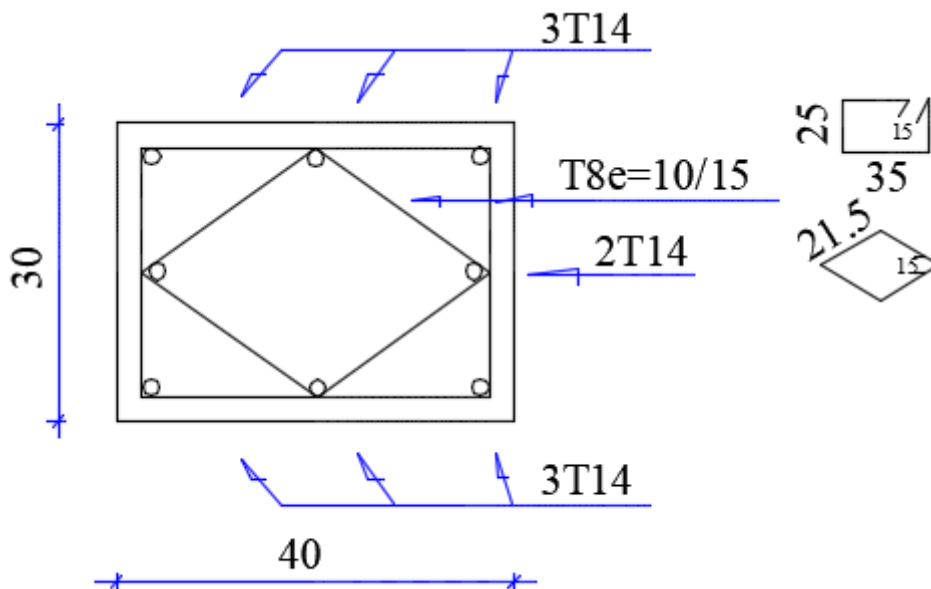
Ferrailage du poteau rectangulaire (30x40) cm<sup>2</sup>
